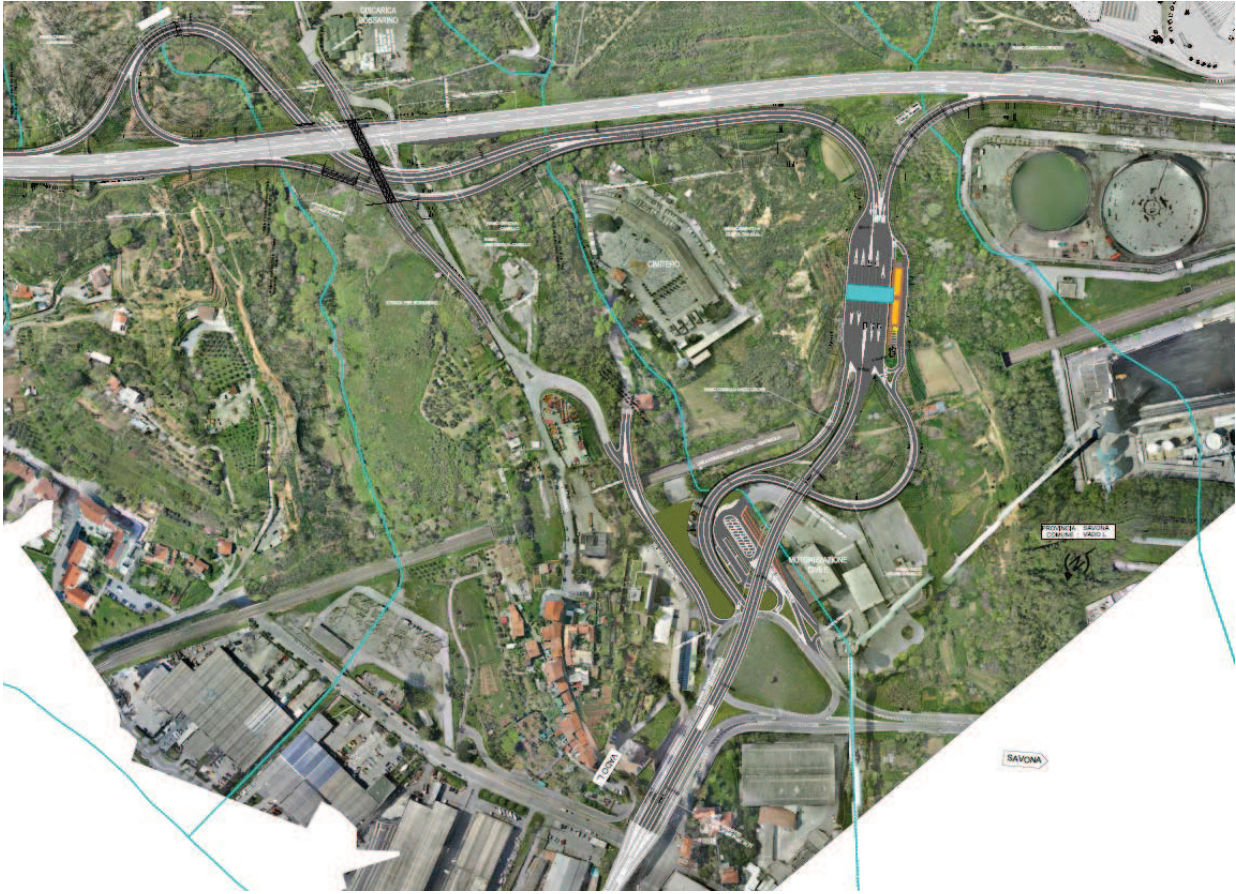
Stralcio della planimetria nella zona della discarica Bossarino
